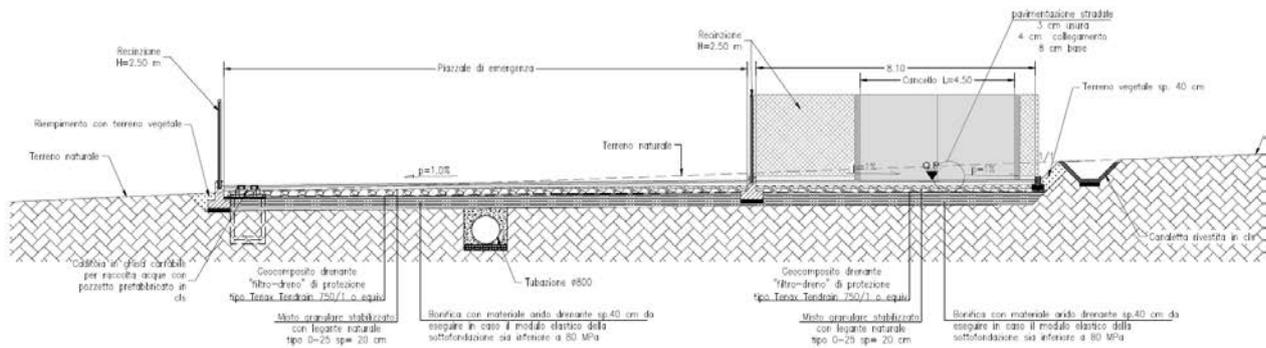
Sezione stradale tipo con piazzale di emergenza
